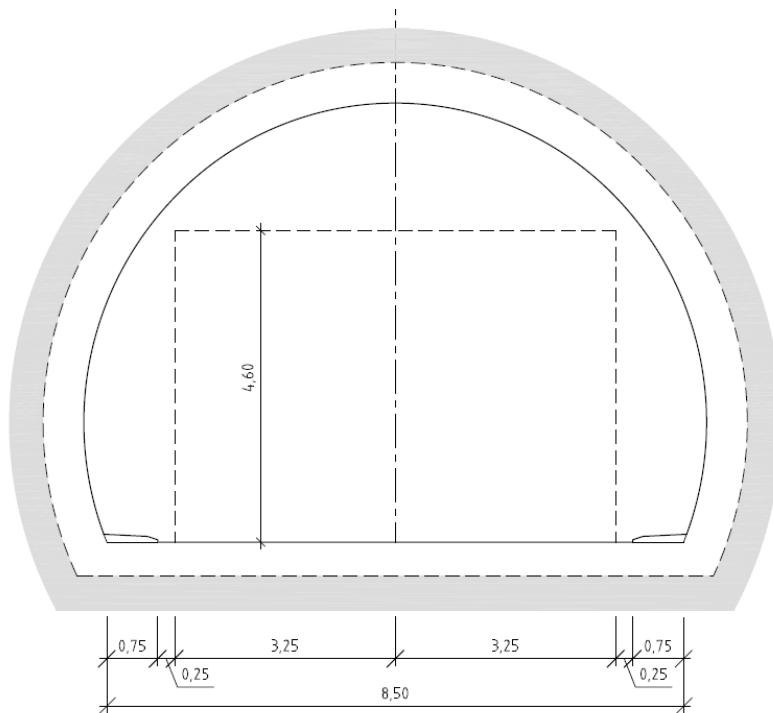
Tunnelprofil T5,5 (mål i m)
